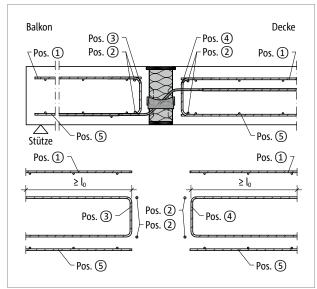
Schöck Isokorb® T Typ QL: Bauseitige Bewehrung
